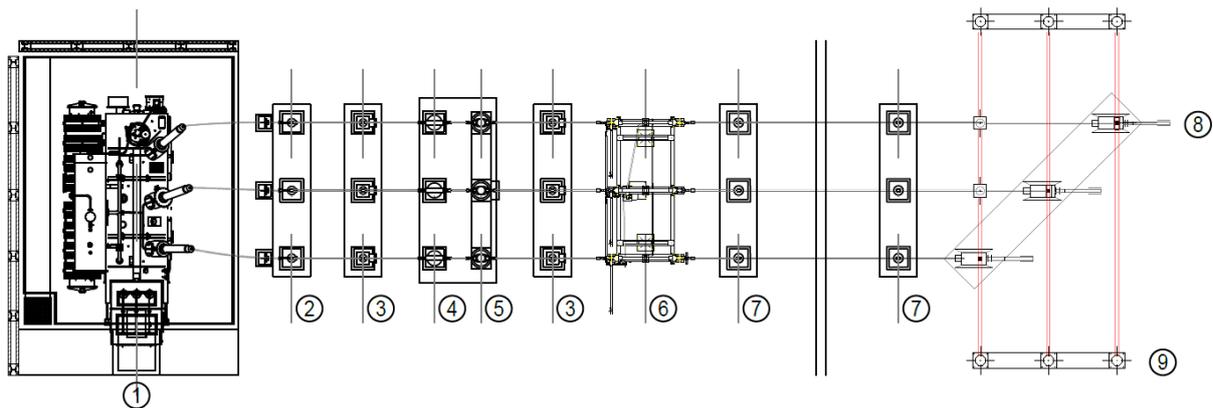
vista in pianta Stallo di Trasformazione MT/AT della Società Proponente
